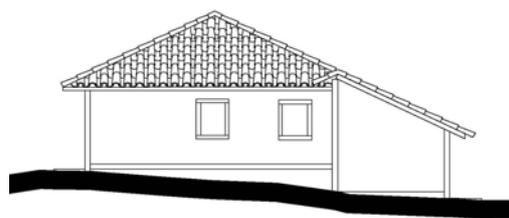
Fachada Sudeste (Acervo PROAU/FAU/UnB).
